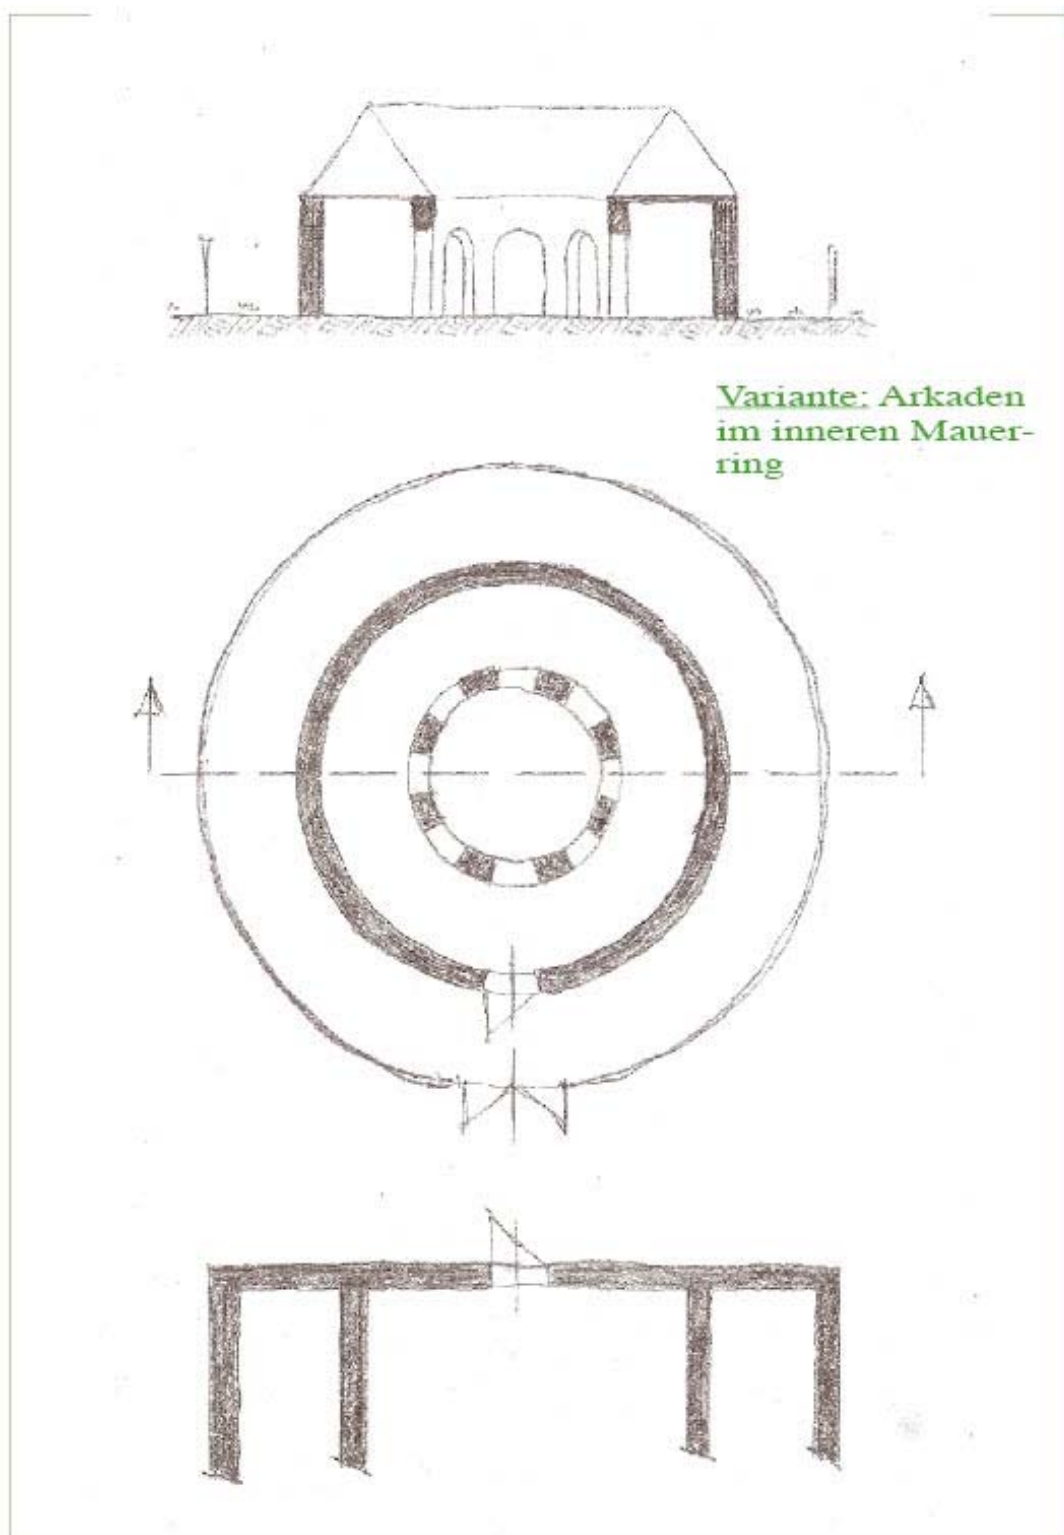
Gänsestall, Schnitt und Grundriss
